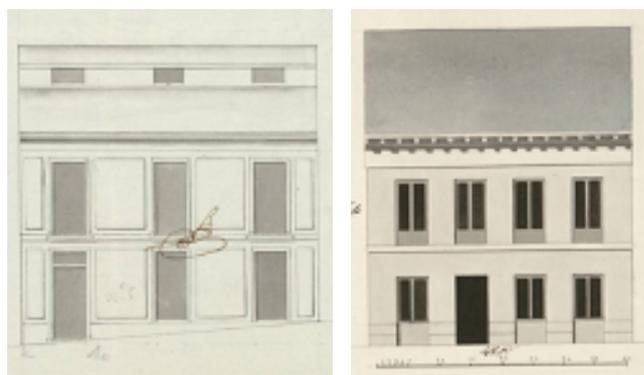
Alzados originales: a) Embajadores 46 [2+s] (AVM, 1-53-43, 1793) y b) Oso 9 [2+c] (AVM, 1-59-16, 1823).
